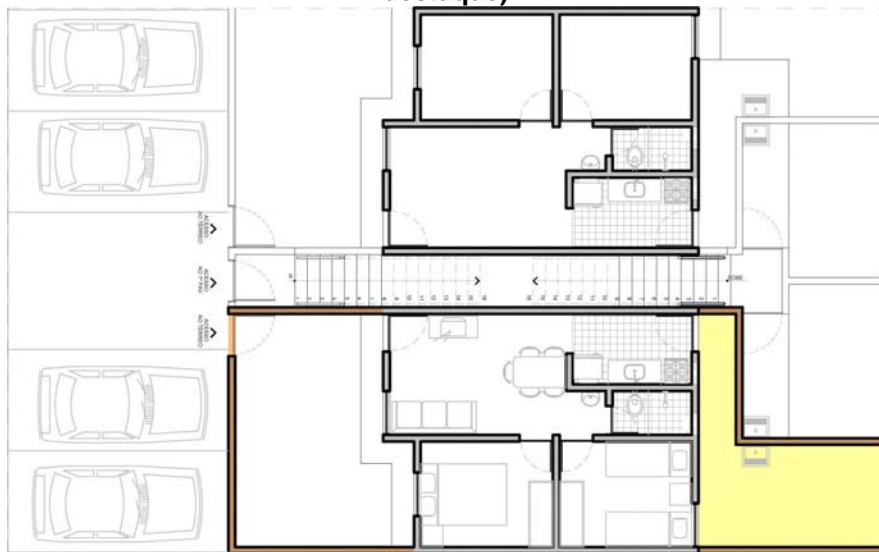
Planta-baixa original das unidades destacando em vermelho a área útil disponível para expansão da moradia e em laranja as áreas molhadas.
